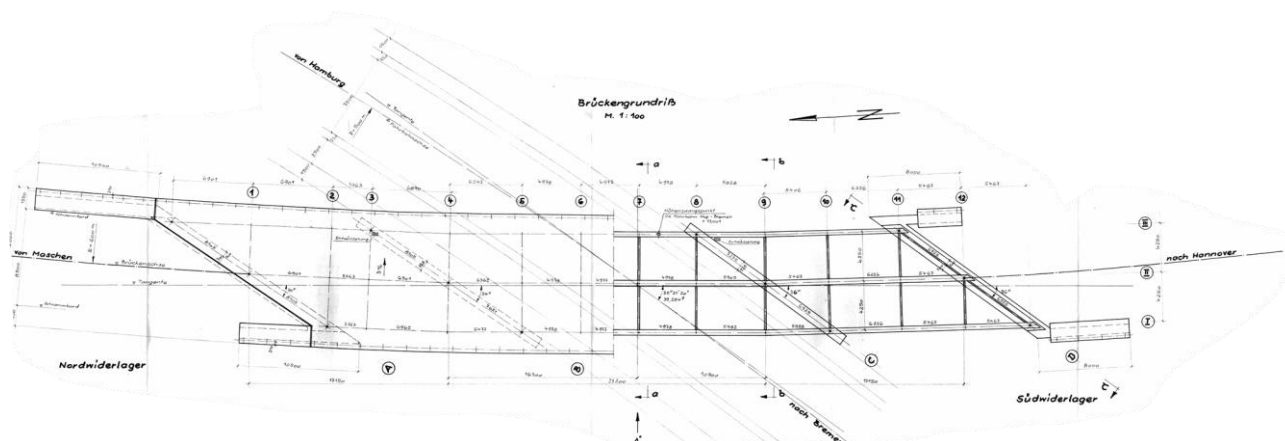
Brückengrundriß - unmaßstäblich (Auszug aus Bestandsplan zu BW 435)
